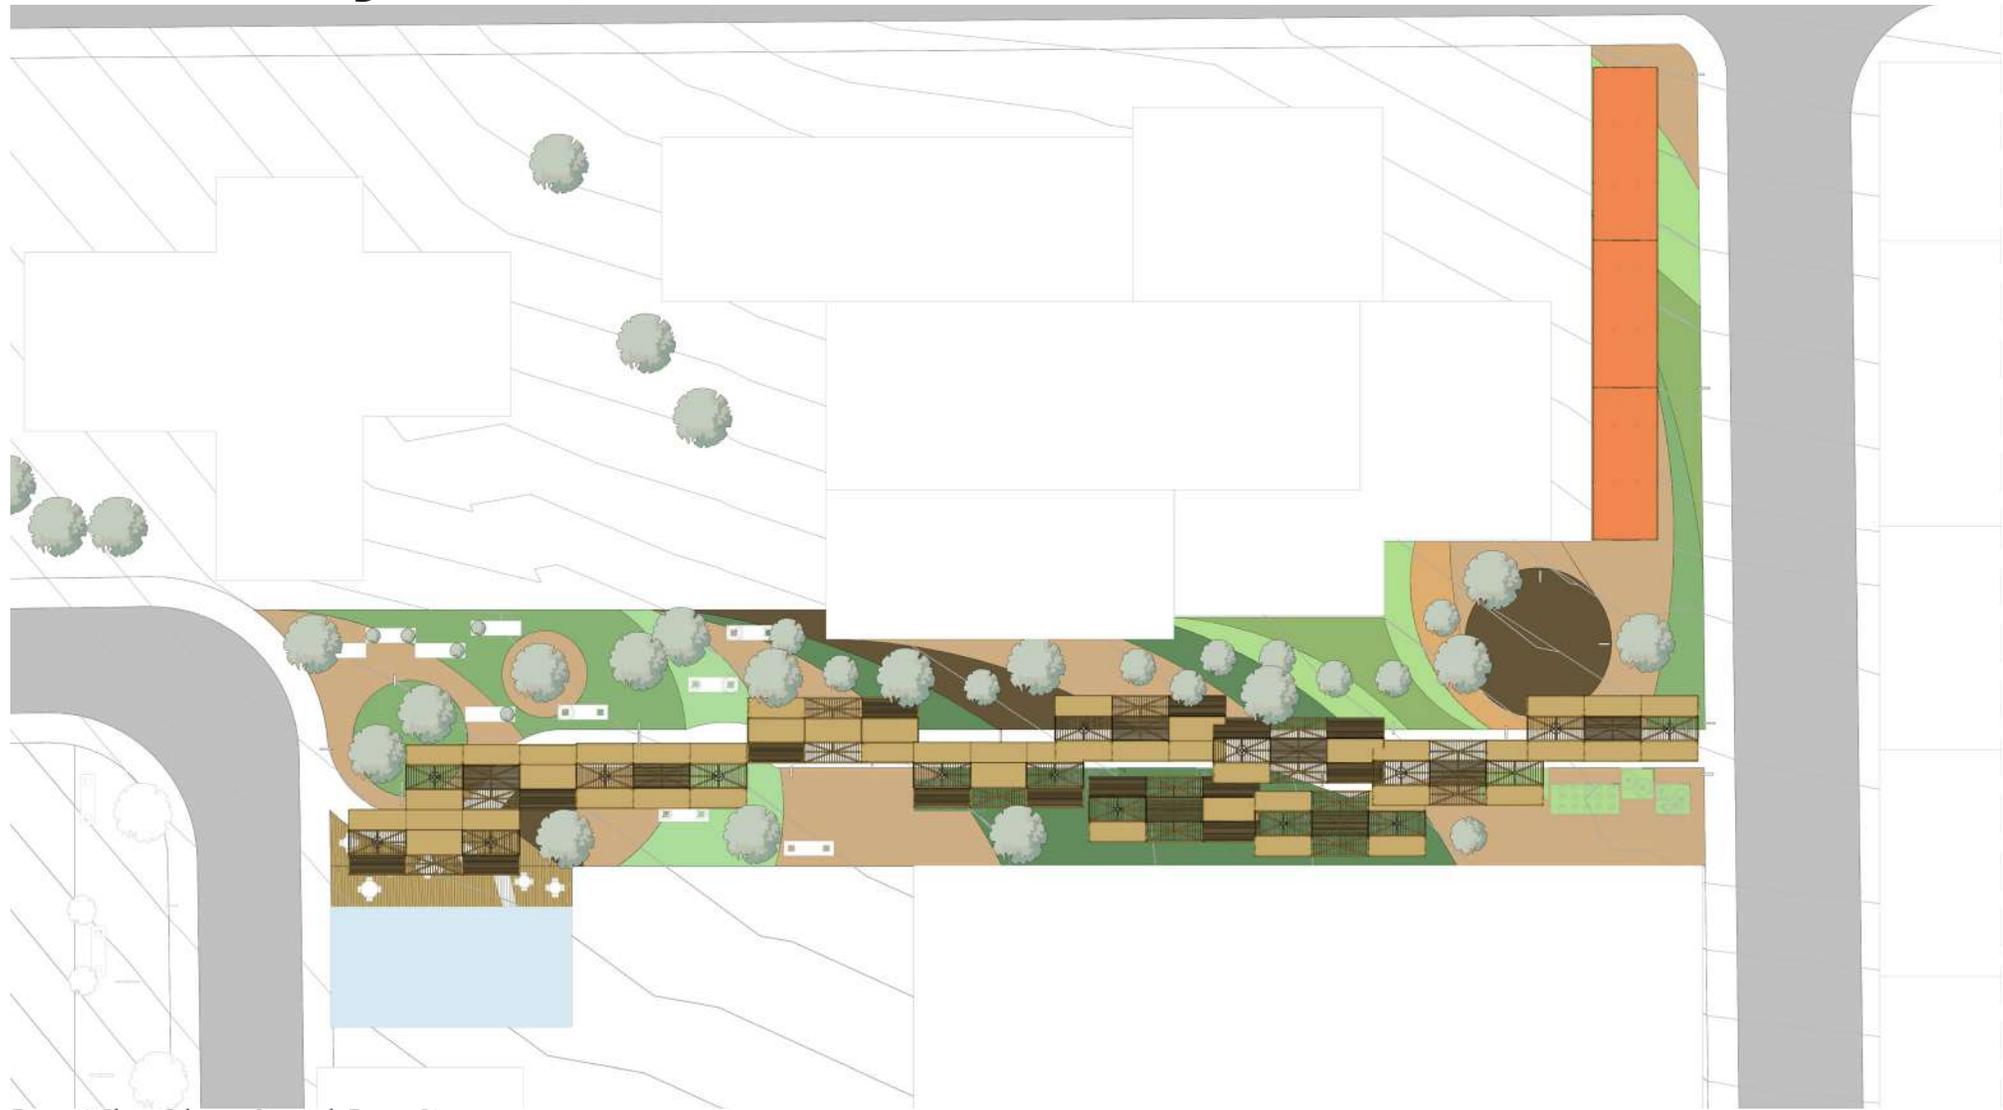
Planta Cobertura Sistema de Espaços Livres
